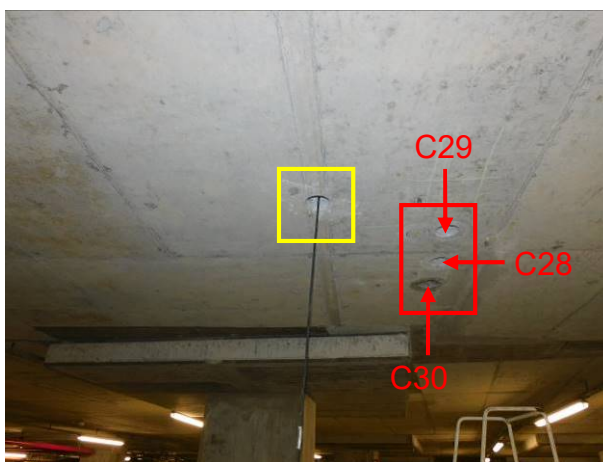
Ensaaios “in situ” realizados em lajes de pavimento. Piso 0. Zona Z(0).2, com extração de três carotes (designadas de C28, C29 e C30, assinaladas a encarnado) destinadas a ensaios laboratoriais (ensaios de compressão). Extração de carote adicional, para aferição da espessura da laje (assinalada a amarelo).
